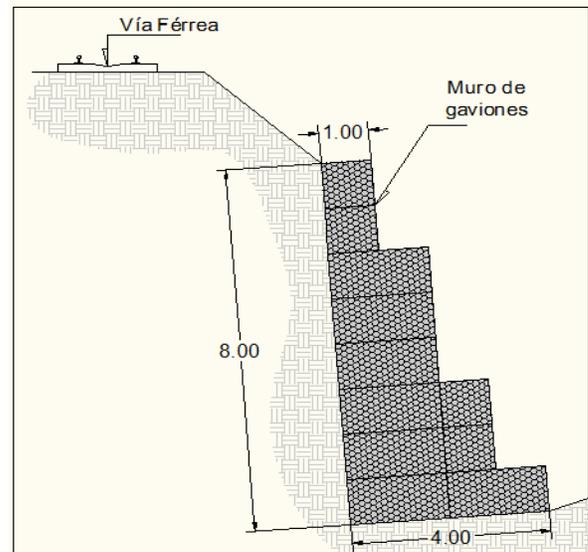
Detalle de obra complementaria #22, (Fuente: Autor)
